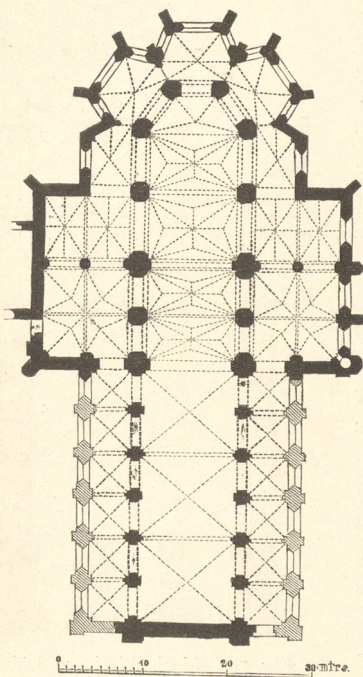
Grundriss von Dargun. (Nach Dohme.)
